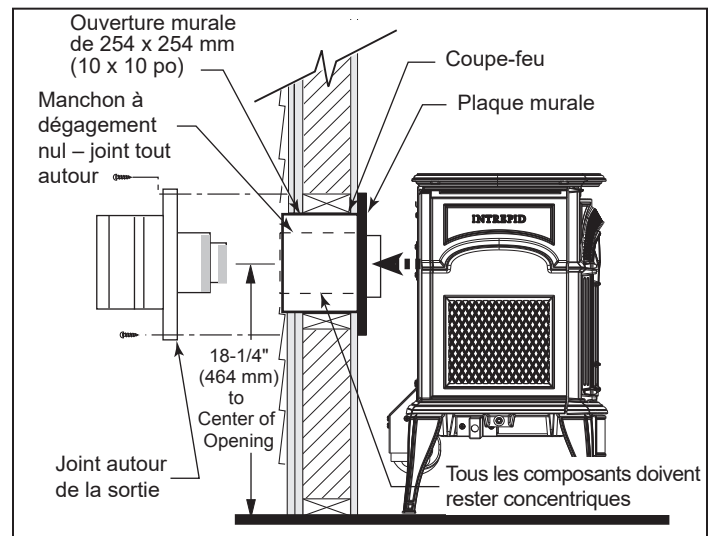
Installation minimale horizontale de la ventilation arrière de l'Intrepid.
